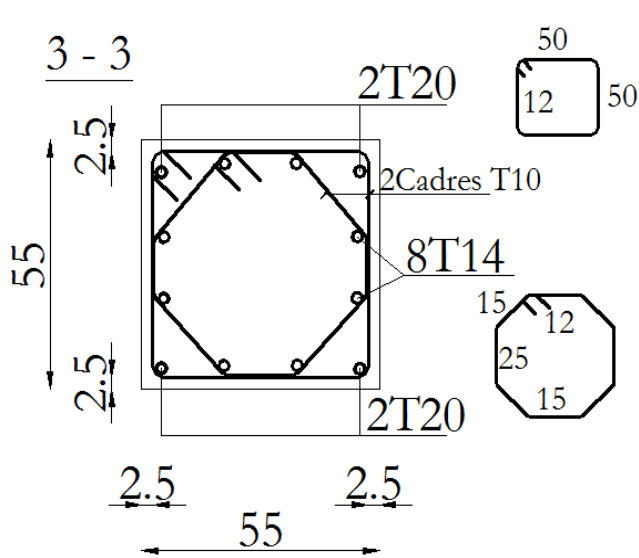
Ferrailage des poteaux 2<sup>ème</sup> et 3<sup>ème</sup> étage
